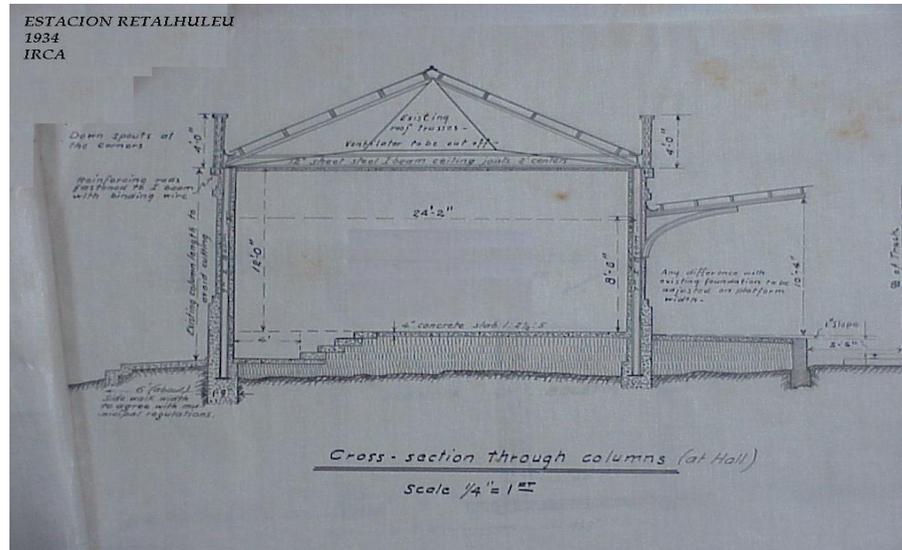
pertenece a los archivos de la Planoteca de FEGUA . oficina Central Guatemala.
